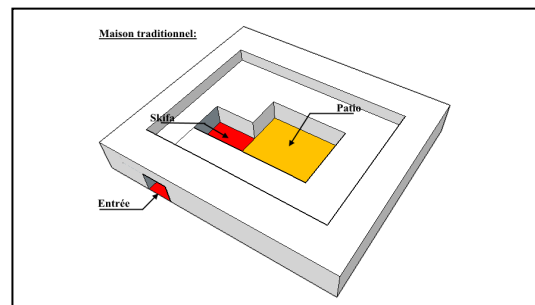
Plan et 3D d'une maison à cour - les ksour-
